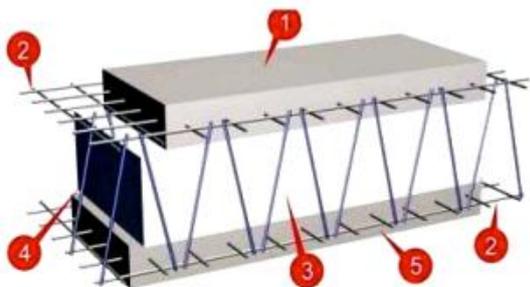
Конструкция 3D – панели: 1 – наружный слой торкретбетона 50-60 мм (класс ниже В20); 2 – сварная арматурная сетка из высокопрочной проволоки диаметром 3 мм и размером ячейки 50х50 мм; 3 – сердечник из вспененного полистирола (для наружных стен 120 мм, для внутренних – 50 мм, для несущих – 100 мм); 4 – диагональ из нержавеющей или оцинкованной проволоки диаметром 4 мм; внутренний слой торкретбетона 50 мм (класс не ниже В20)
